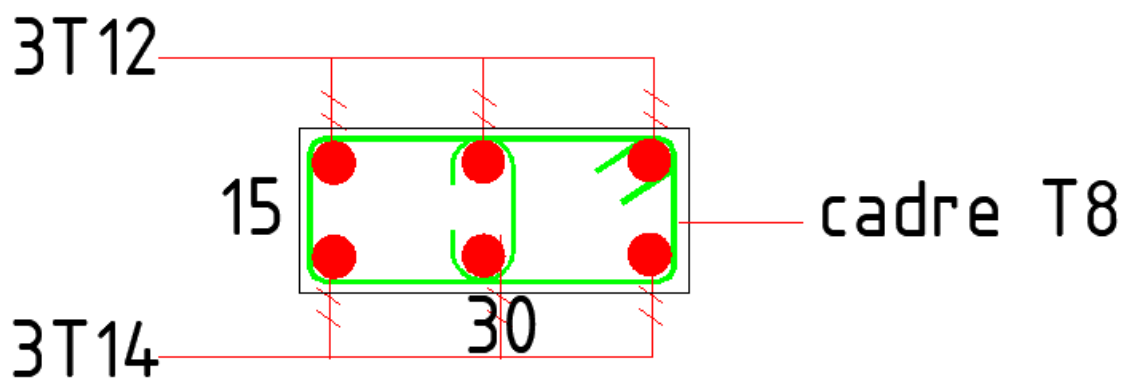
Schéma du ferrailage de la poutre noyée.
